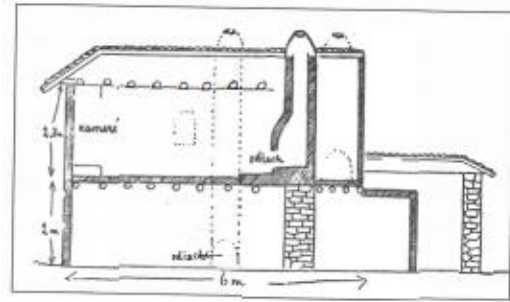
План будинку Асма-кую, 41. Поздовжній розріз [11] / Fig. 4. House plan Asma-kuei, 41. Longitudinal section [11]
